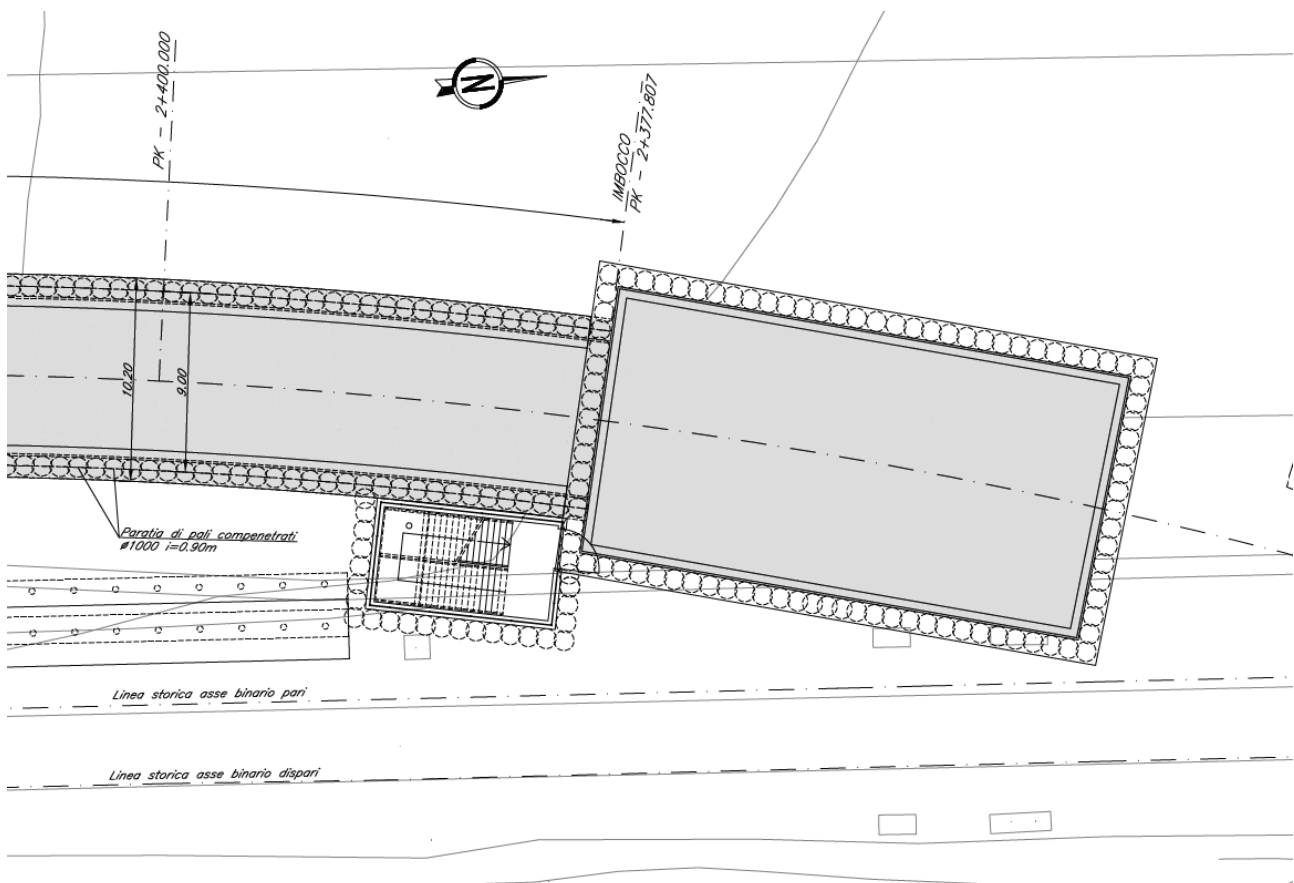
Planimetria pozzo di estrazione TBM prevista in PD
